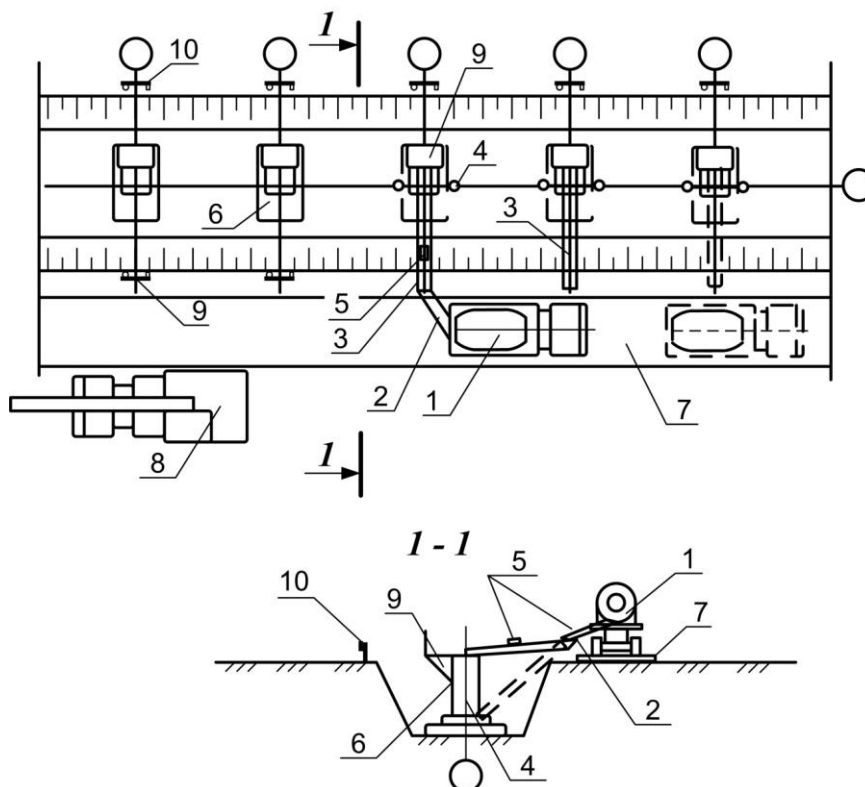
Схема бетонирования фундамента при помощи автобетоносмесителя и виброжелоба:
